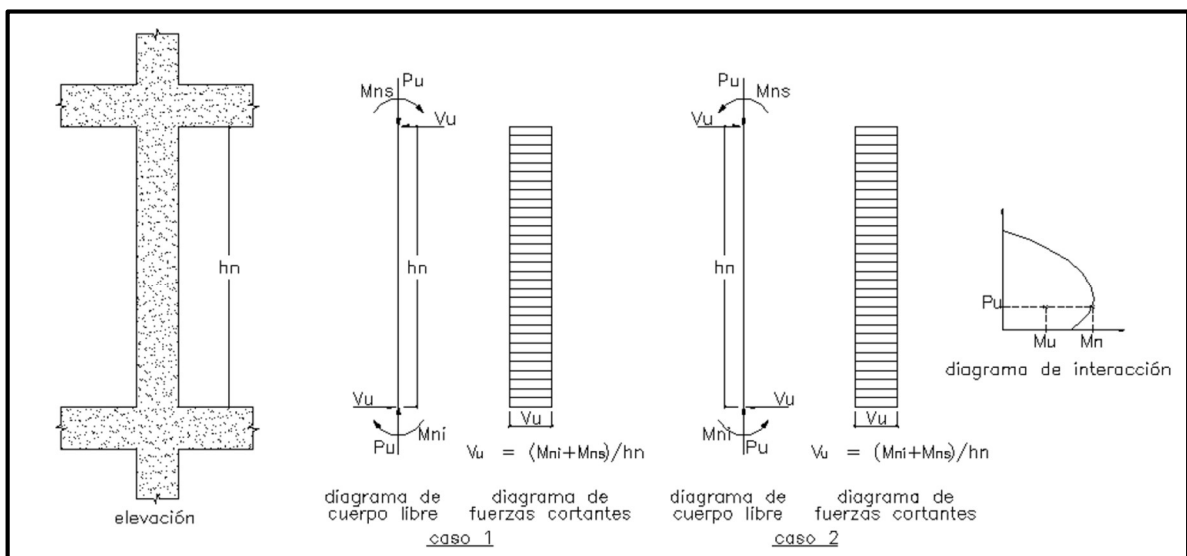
Fuerzas cortantes - Muros estructurales
